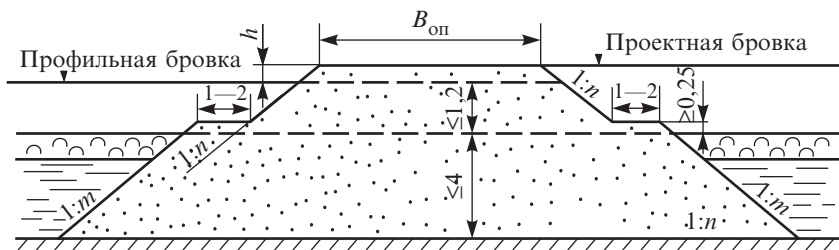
Поперечный профиль насыпи на болотах III типа глубиной до 4 м при поперечном уклоне основания не круче 1:20 (размеры в м)
